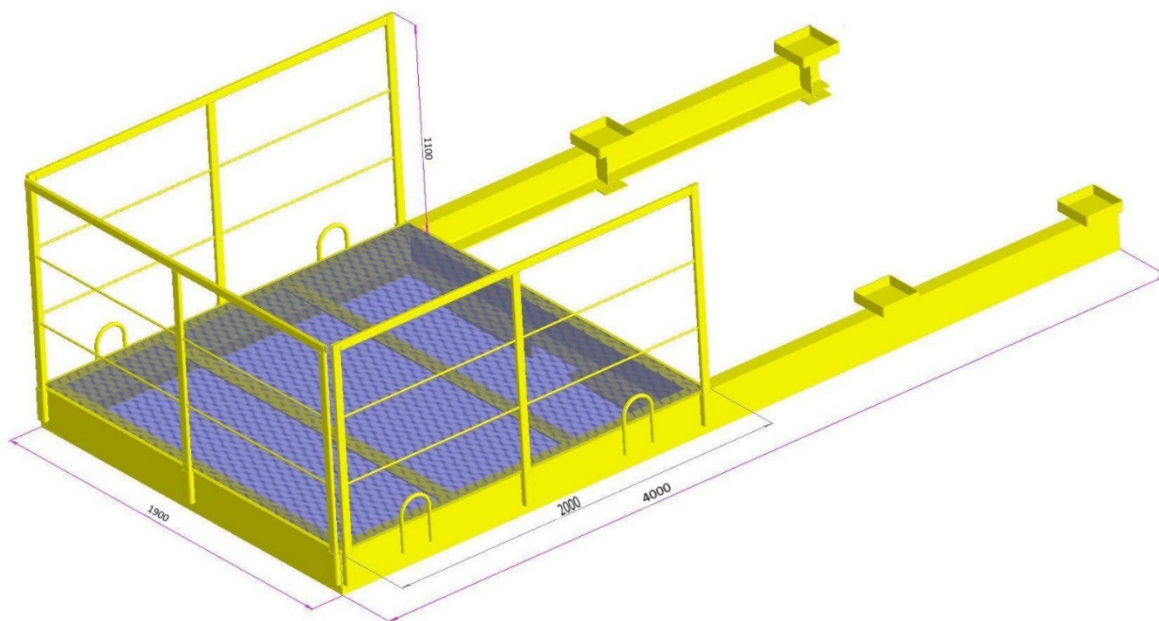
Грузоприемная площадка ВП-1 с металлическим настилом
